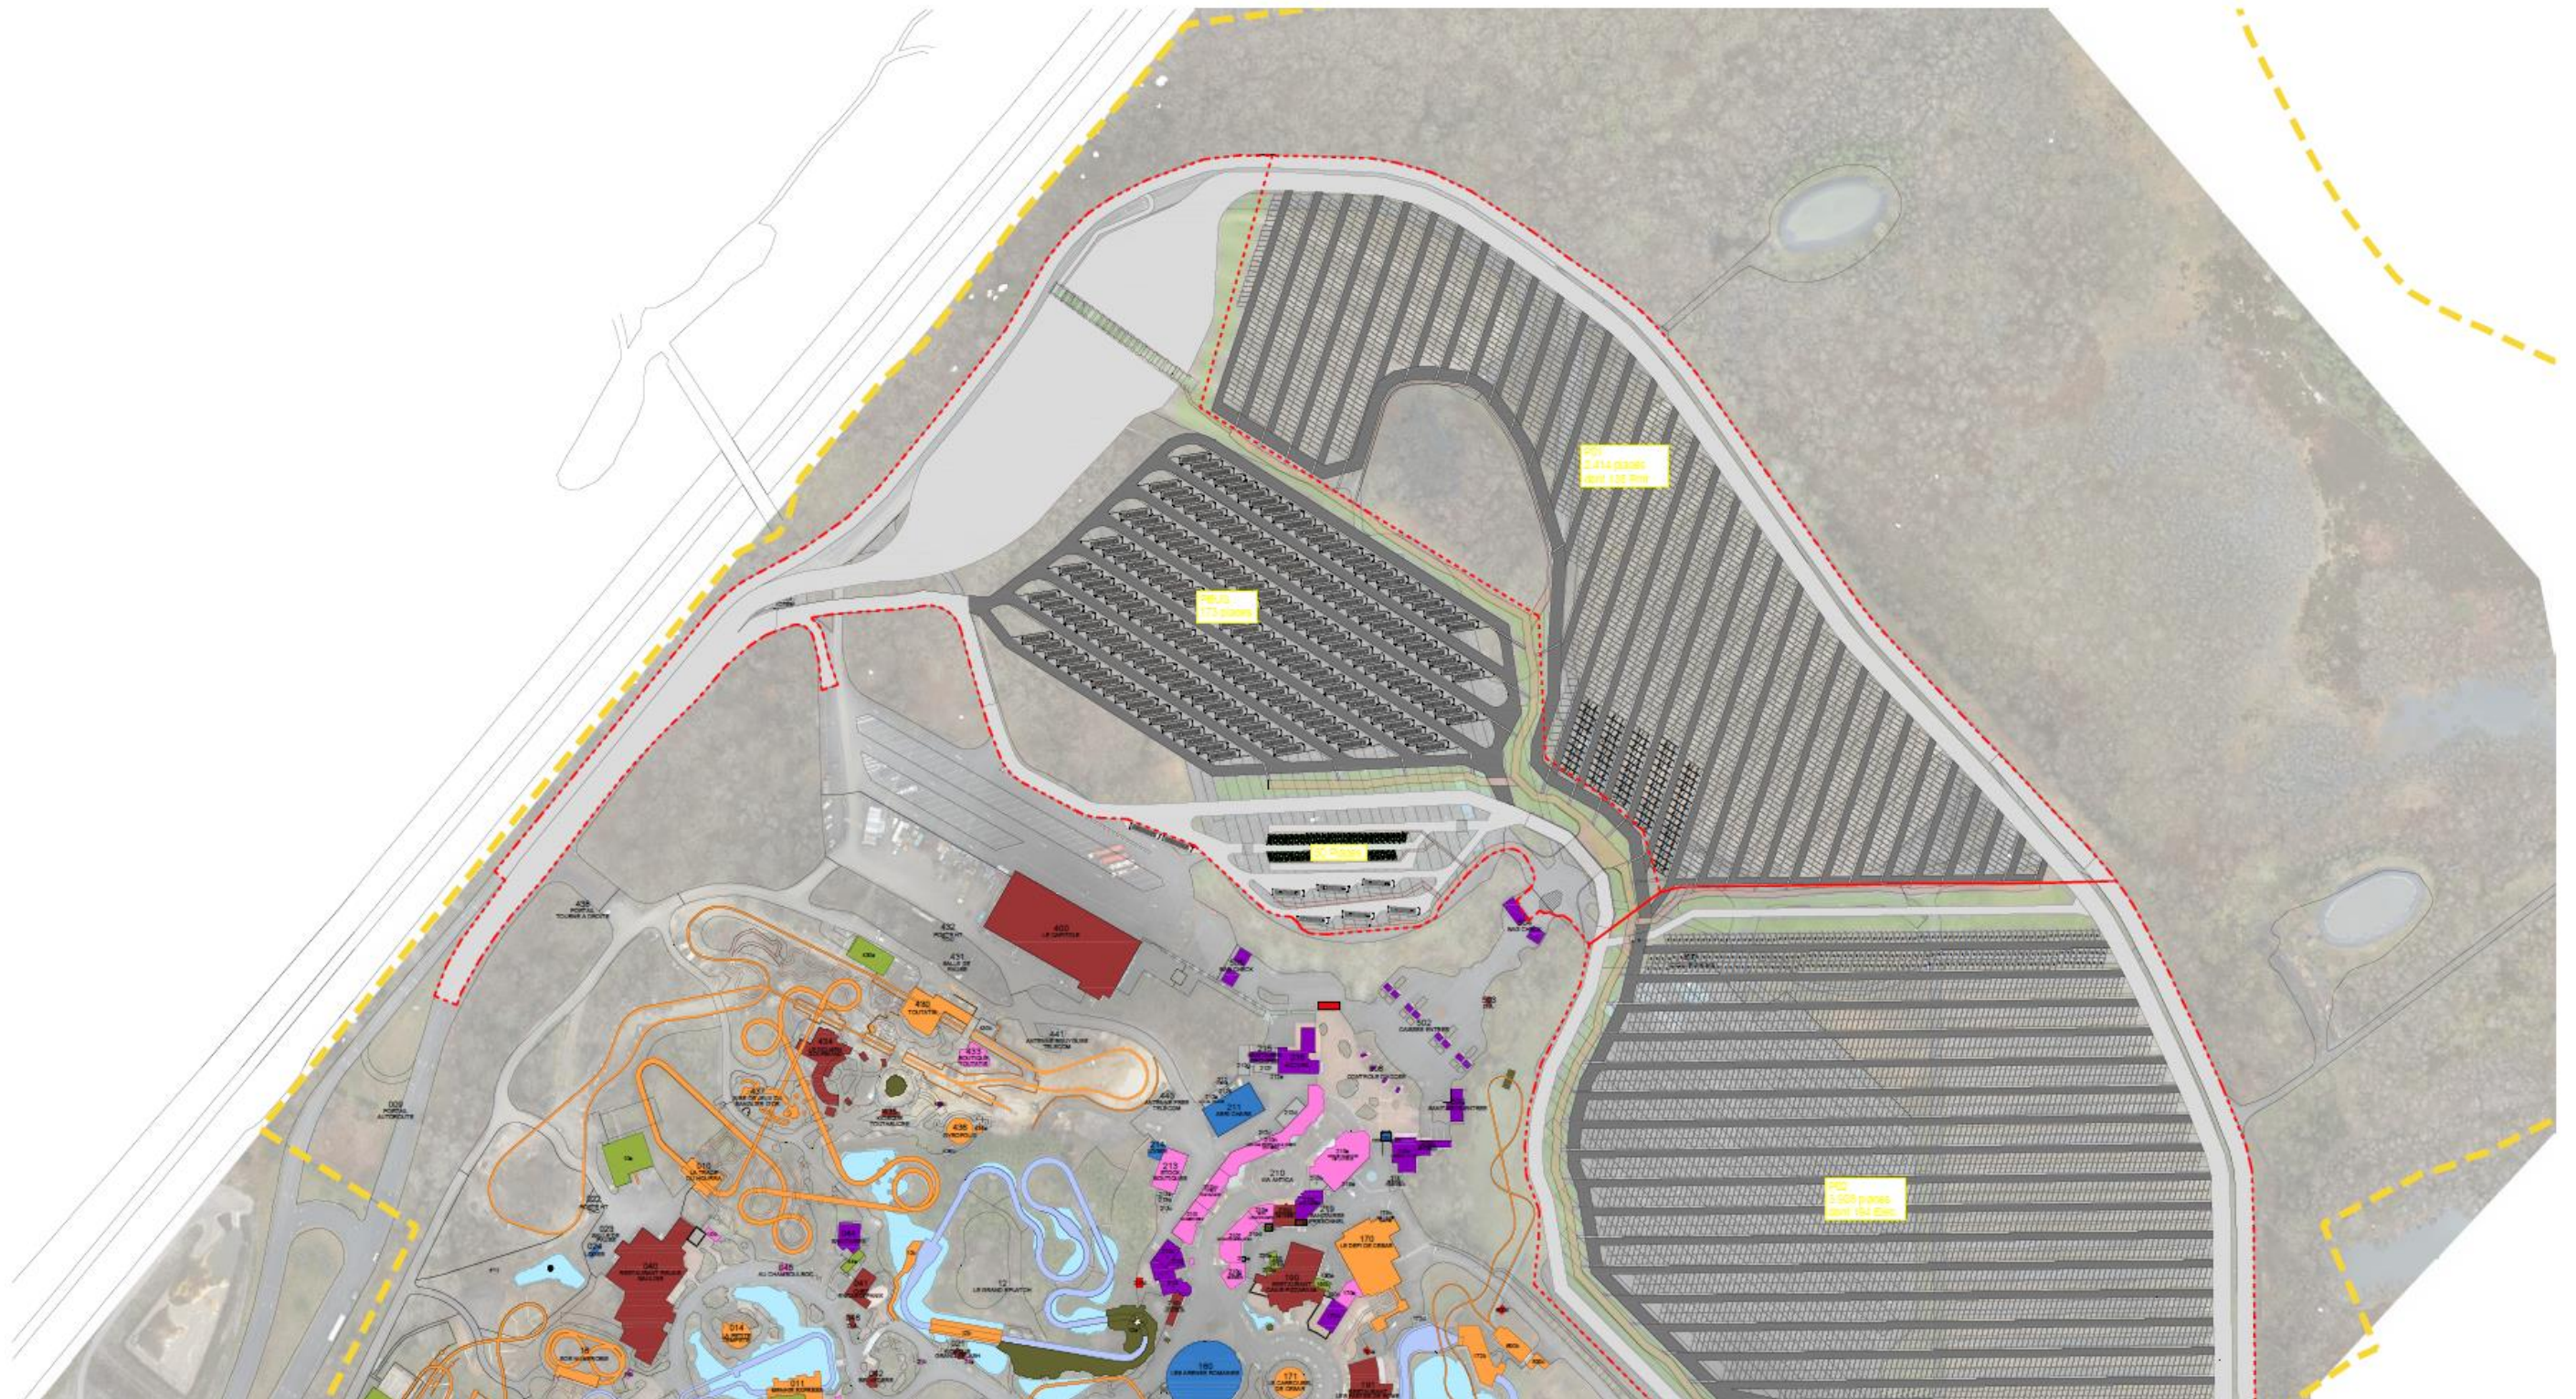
Plan de localisation des ouvrages – Plan 1/3 (Parc Astérix)
